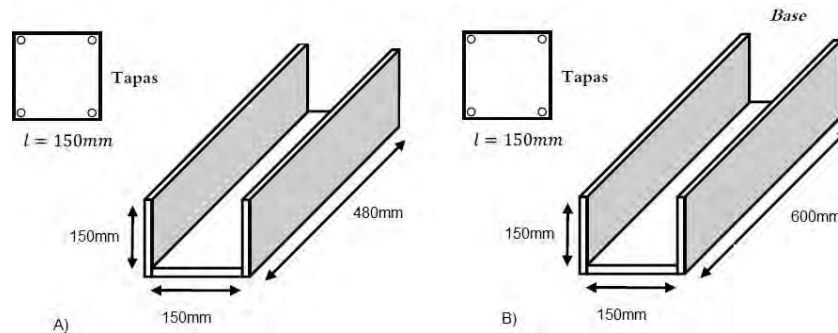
Dimensiones de los moldes de acero utilizados para la fabricación de los elementos estructurales.
